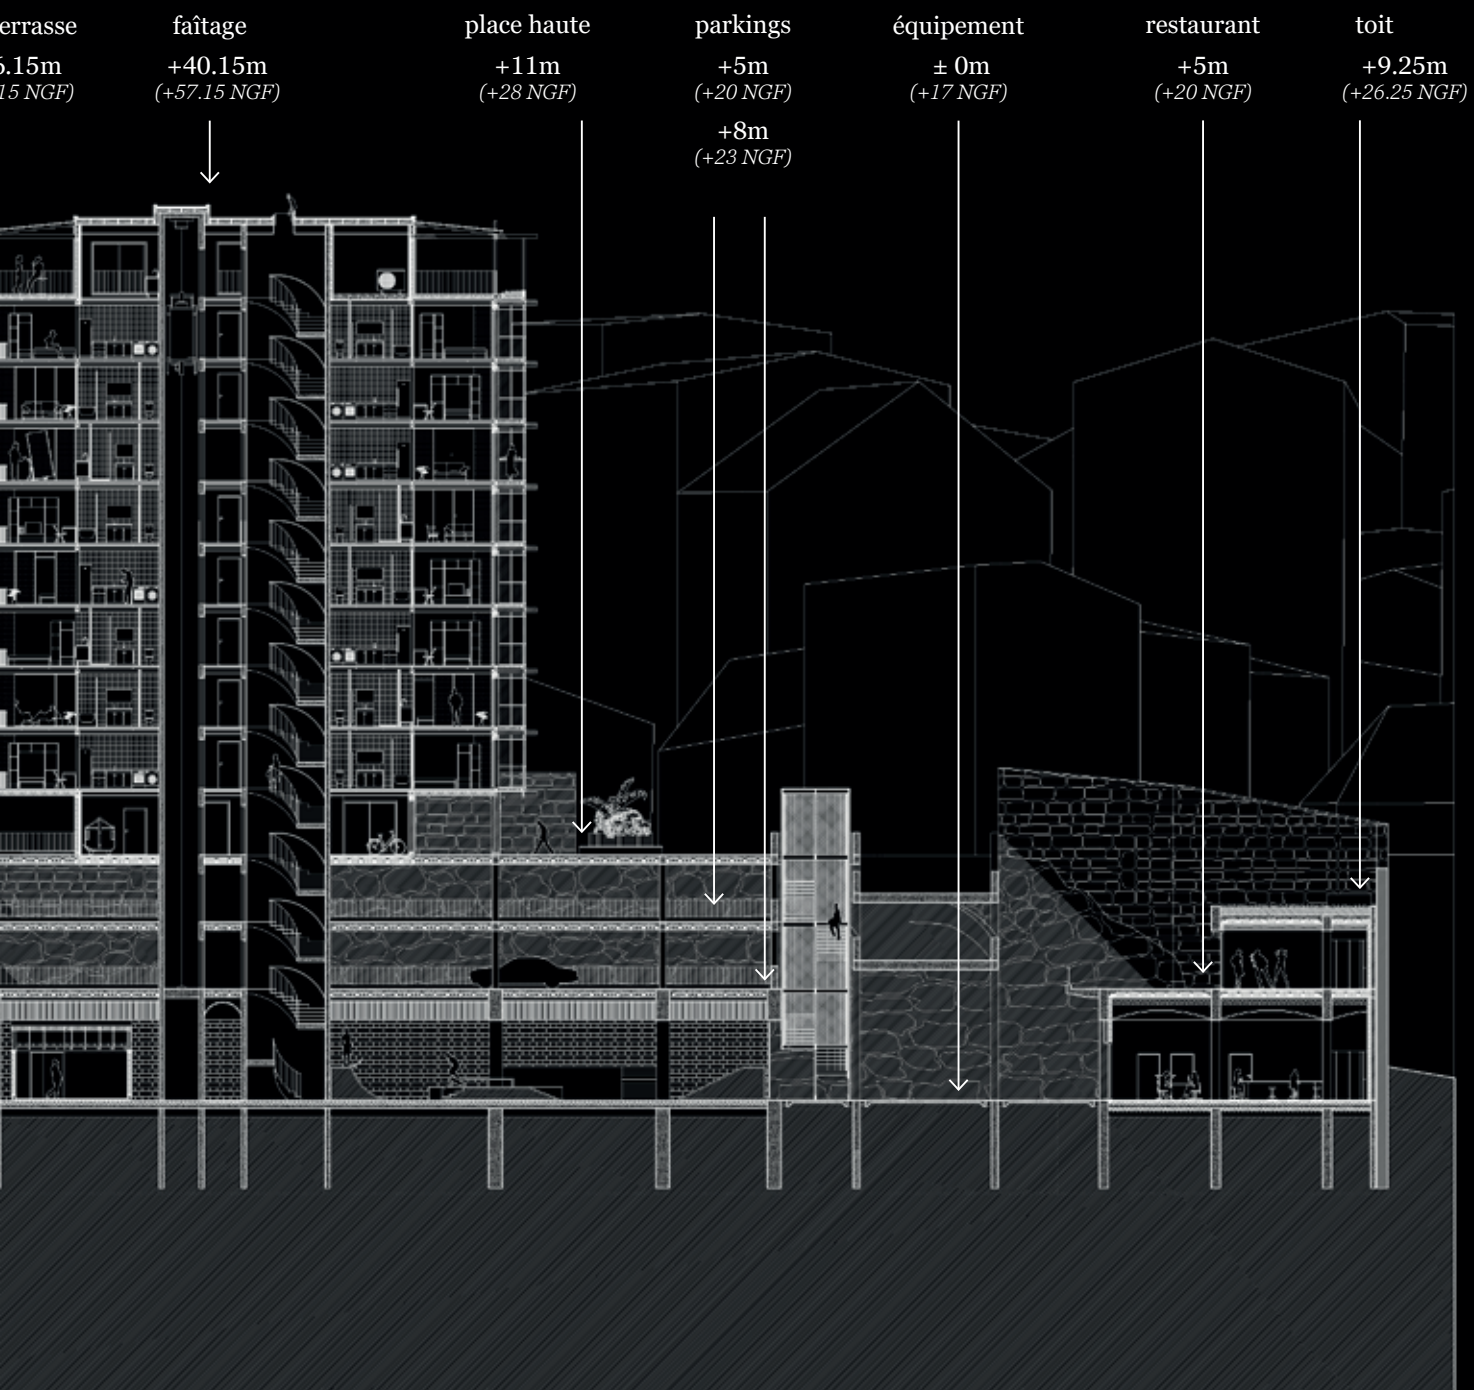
Coupe longitudinale, un projet en 3 couches traversées par des circulations verticales
